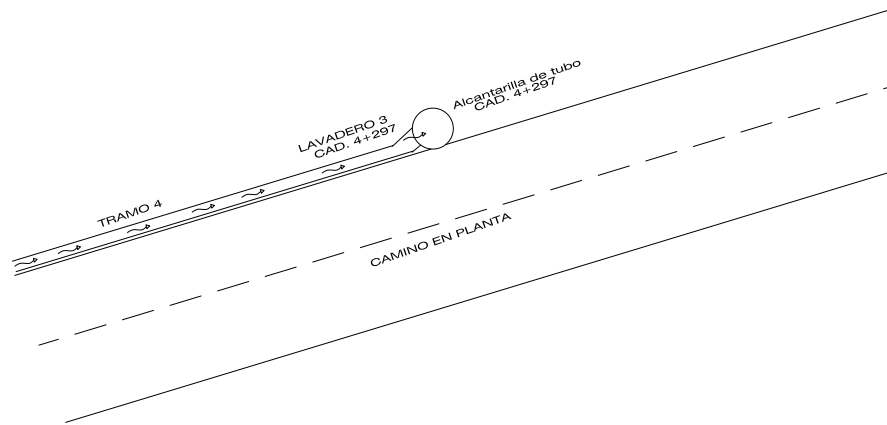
Ubicación de lavadero 3 salida hacia alcantarilla de tubo cad. 4+297.
